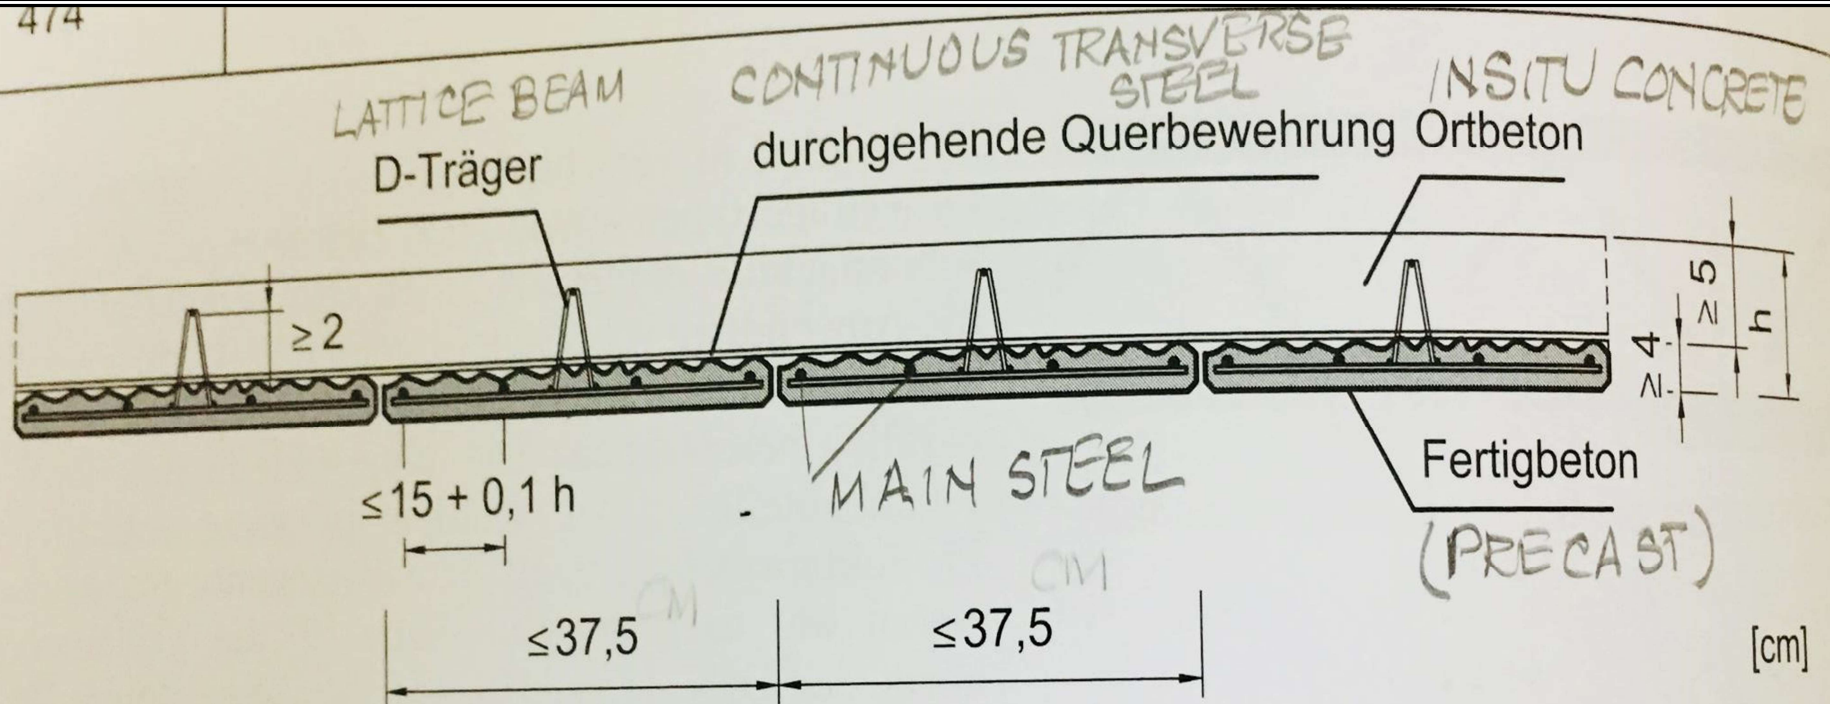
Streifenelemente mit Gitterträgern aus [17]
